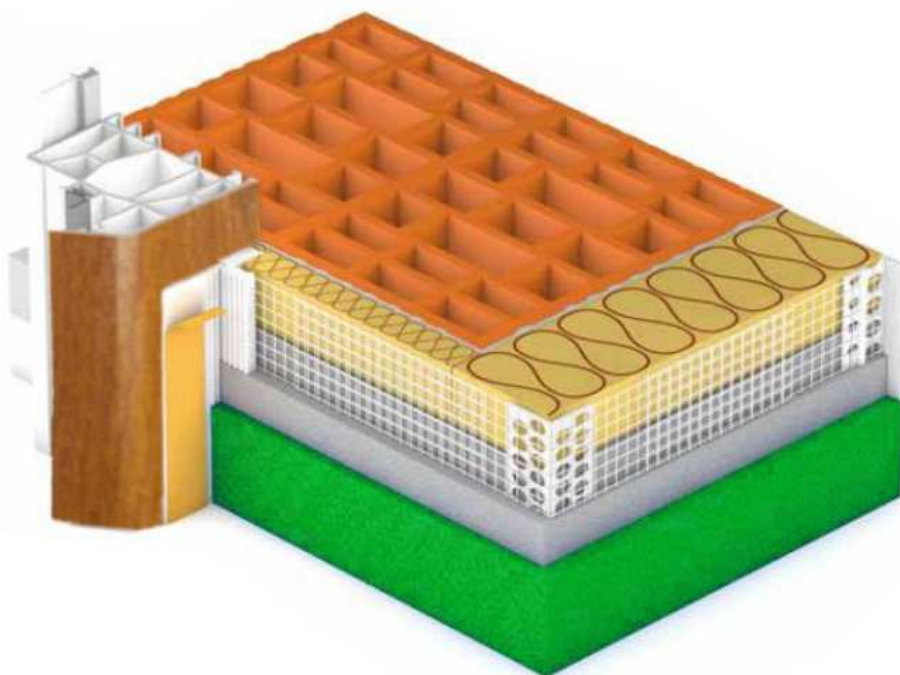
Detail - přípojovací profil parapetní. Schéma a detail lišty pro napojení zateplení pod parapetem.
